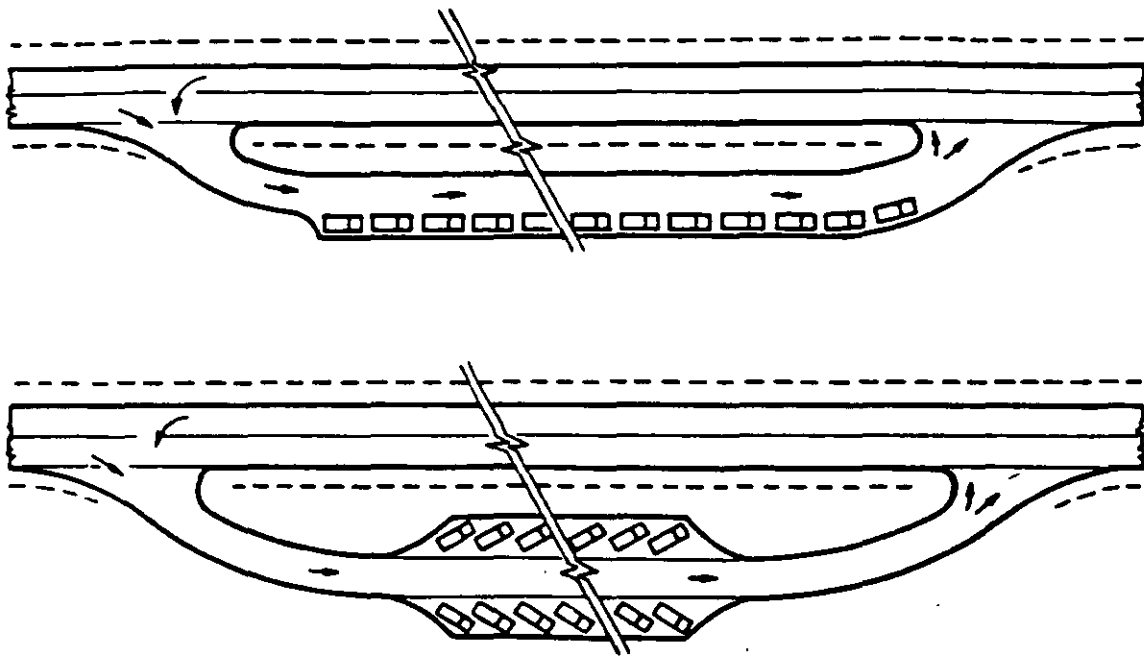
TIPO DE AREAS DE ESTACIONAMIENTO
